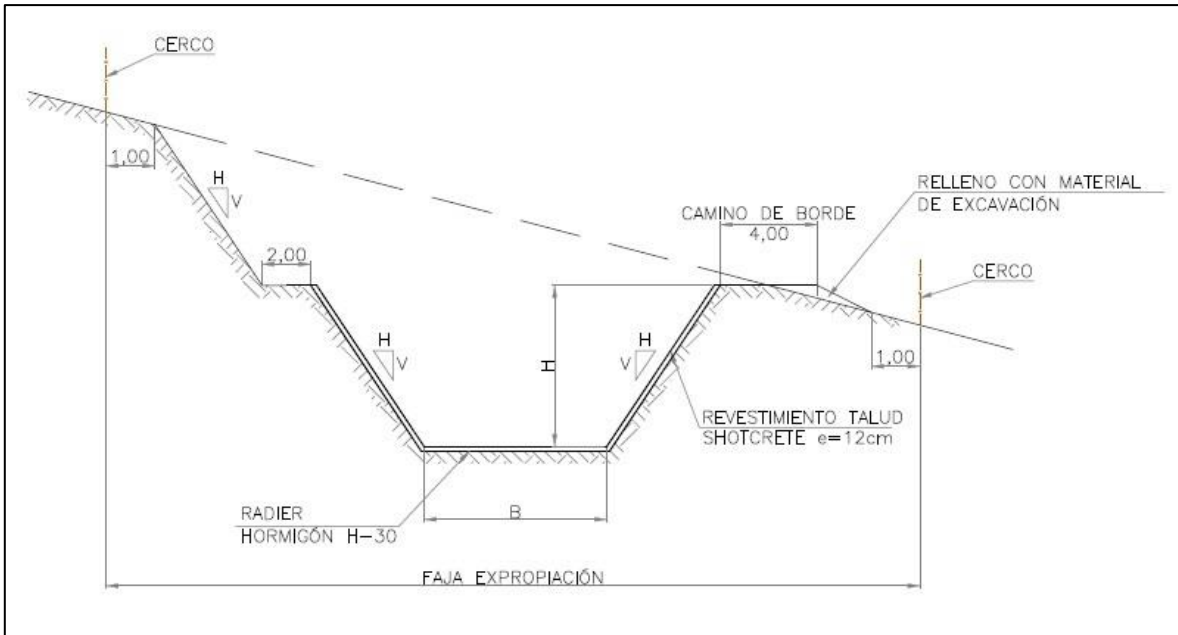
Alternativa 2 de revestimiento hormigón - shotcrete
